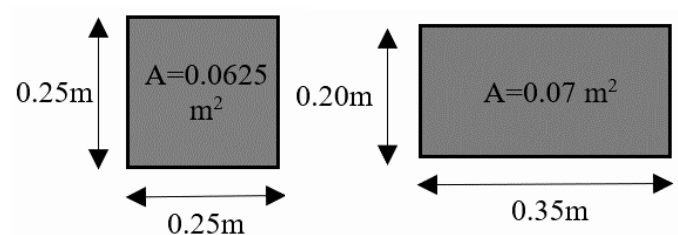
Dimensiones Mínimas de una Columna DMO. Fuente: Propia
